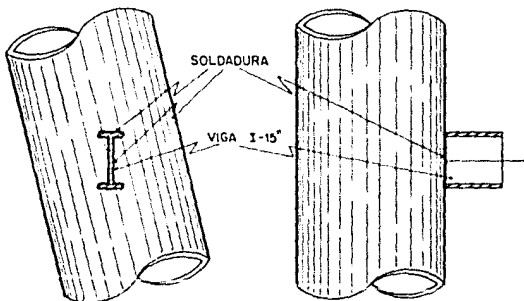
Tramos de viga I-15" soldados a los pilotes.
